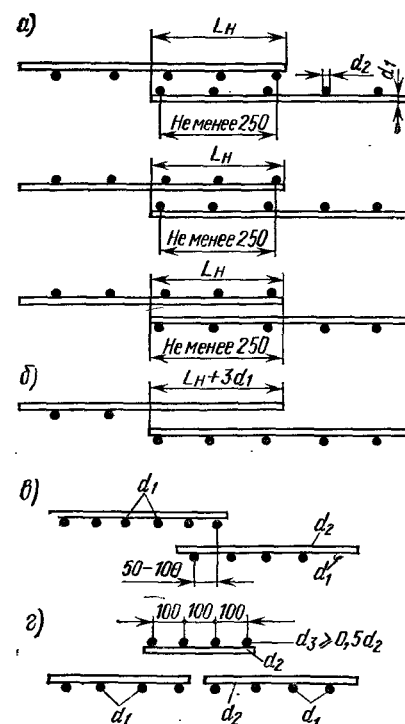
Стыки сварных сеток, выполнение внахлестку без сварки:
